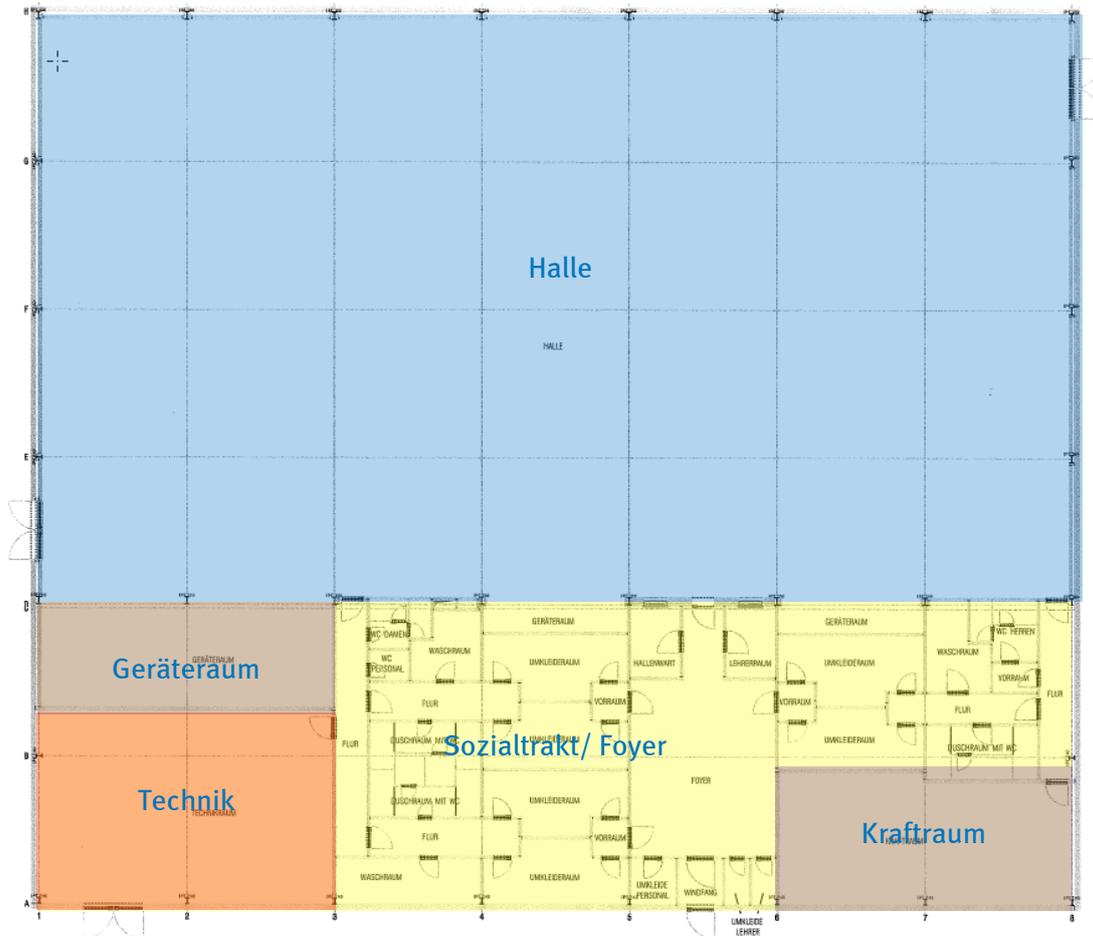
Grundriss TH 15 - Typ SH 24 x 42 (Quelle: ZGM)
